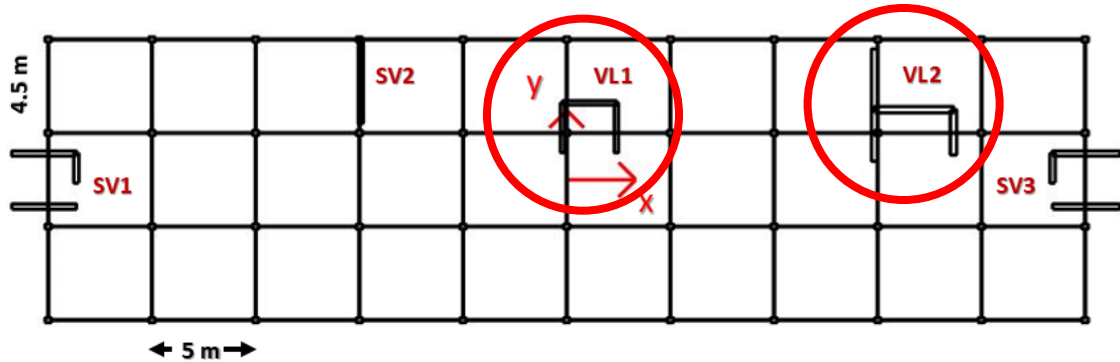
Posizione in pianta dei setti a sezione sottile aperta.
